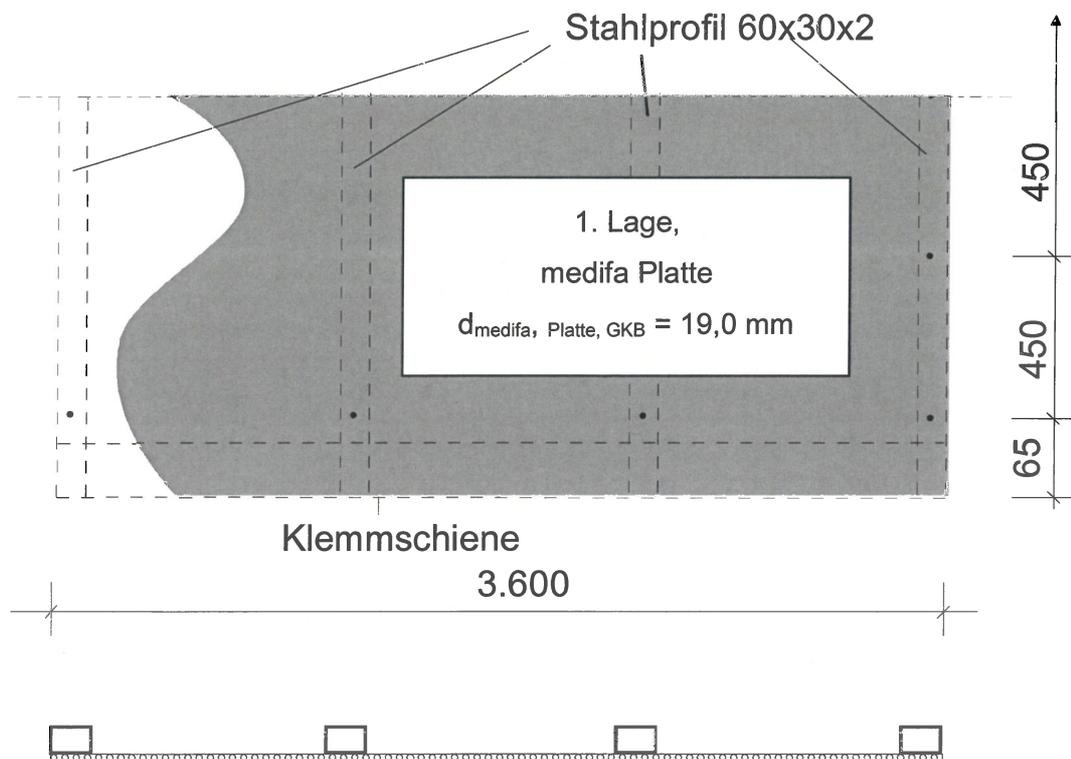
Prinzipzeichnung und Schnitt des Aufbaus der Wandkonstruktion
